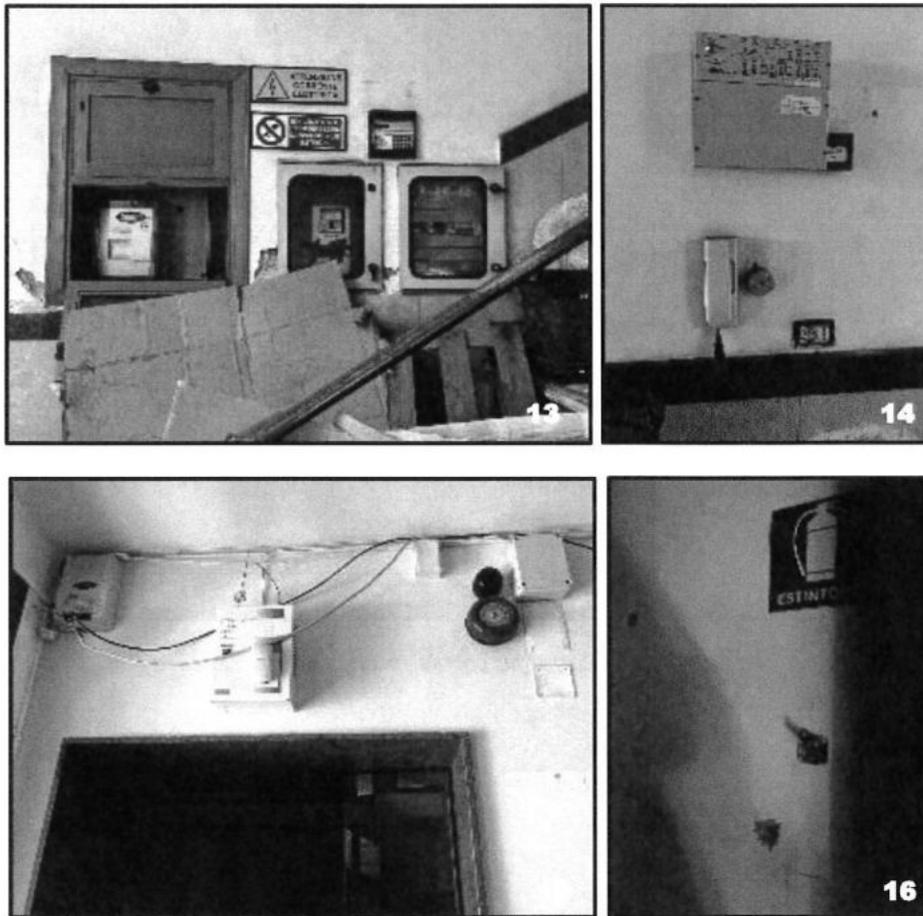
a 16 - Piano terra rialzato: quadri elettrici, centrale sistema antincendio e dispositivi vari
